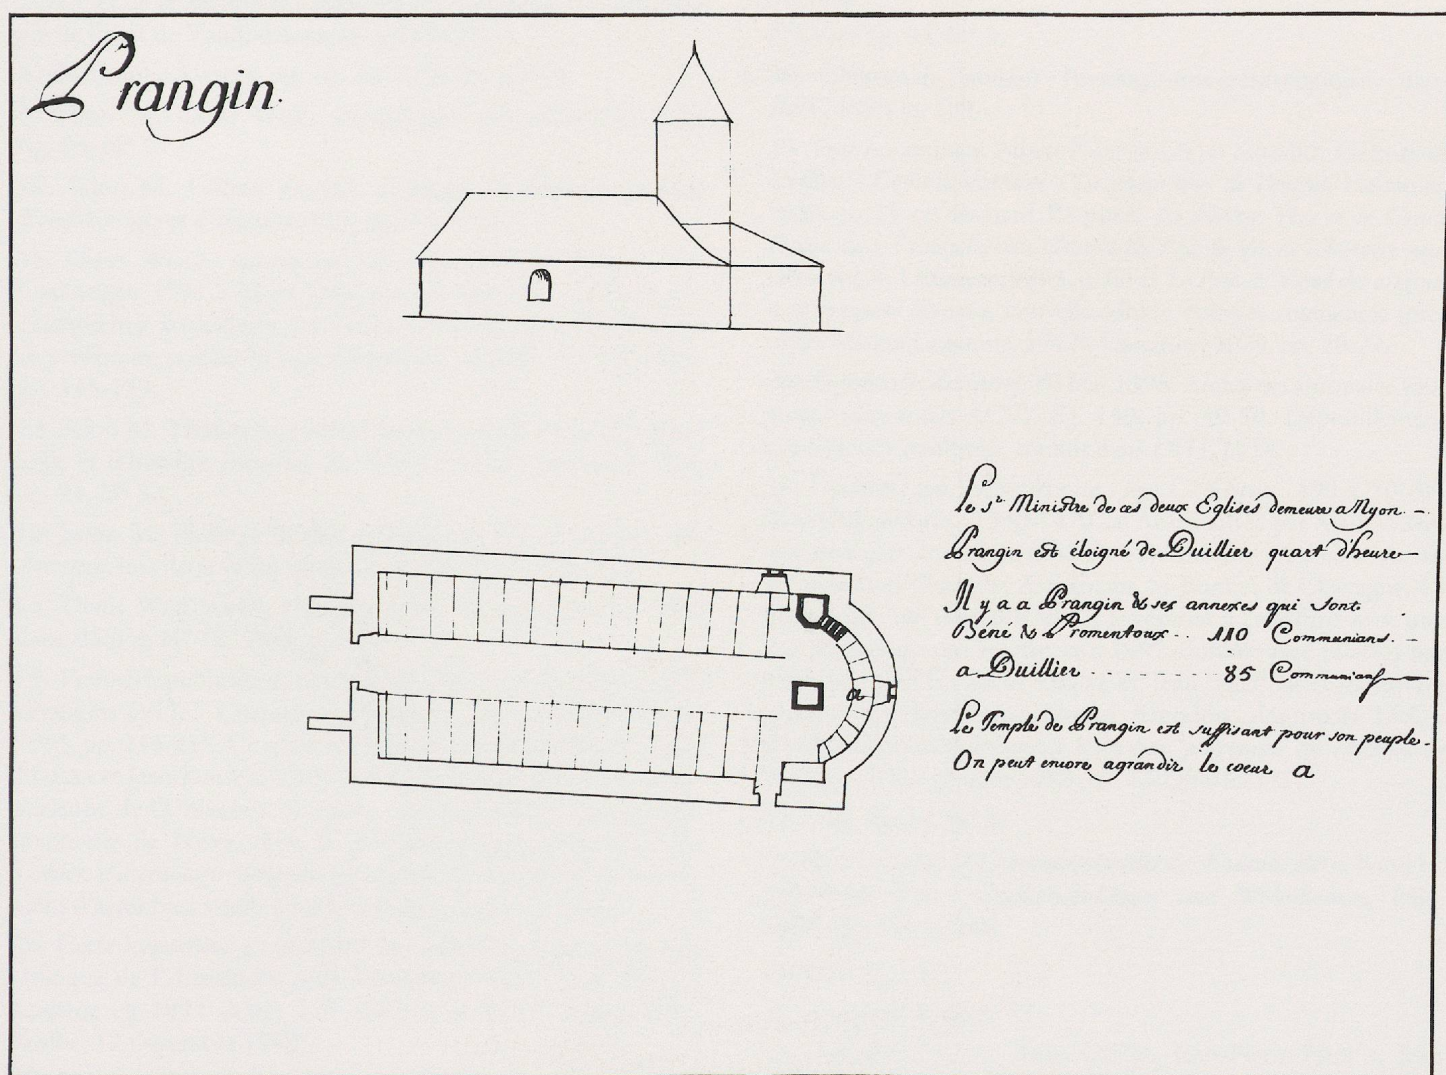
Façade et plan de l'ancienne église de Prangins en 1702 par Gignillat (ACV, GC 1483, f^o 29).
